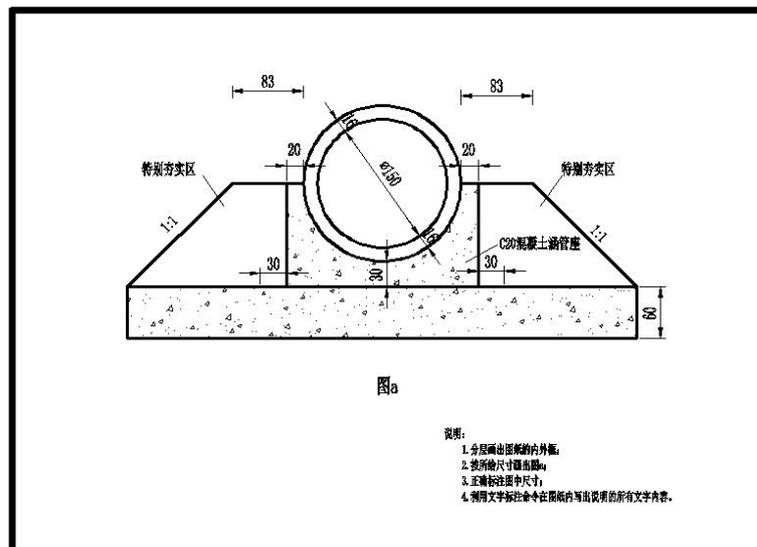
CAD 绘钢筋混凝土圆管涵横断面图
